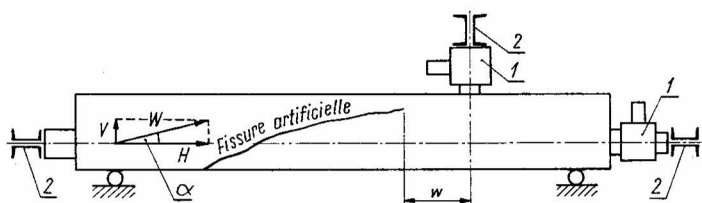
Exemple d'une poutre en béton avec une fissure artificielle dans les essais de BORICHANSKI [11]
